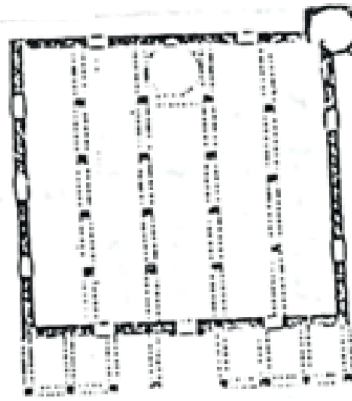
مسقط أفقي للطابق الأول لمدرسة
